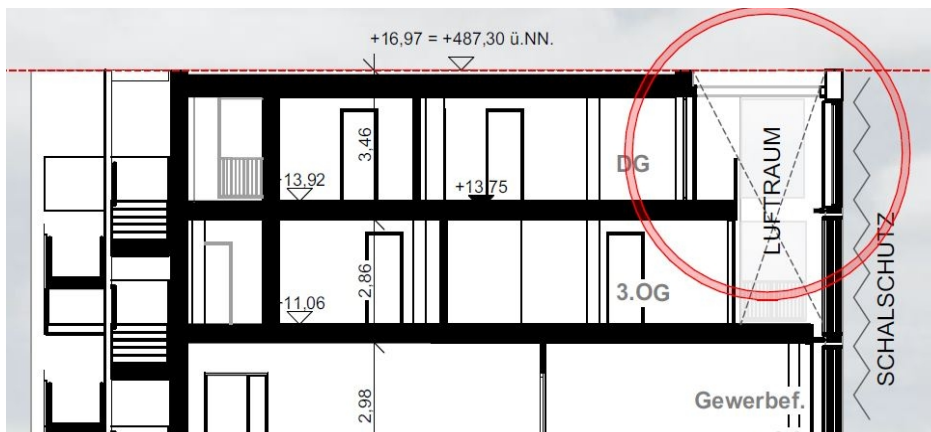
Beispielhafte Darstellung einer Schallschutzkonstruktion im Bereich der Staffelgeschosse
